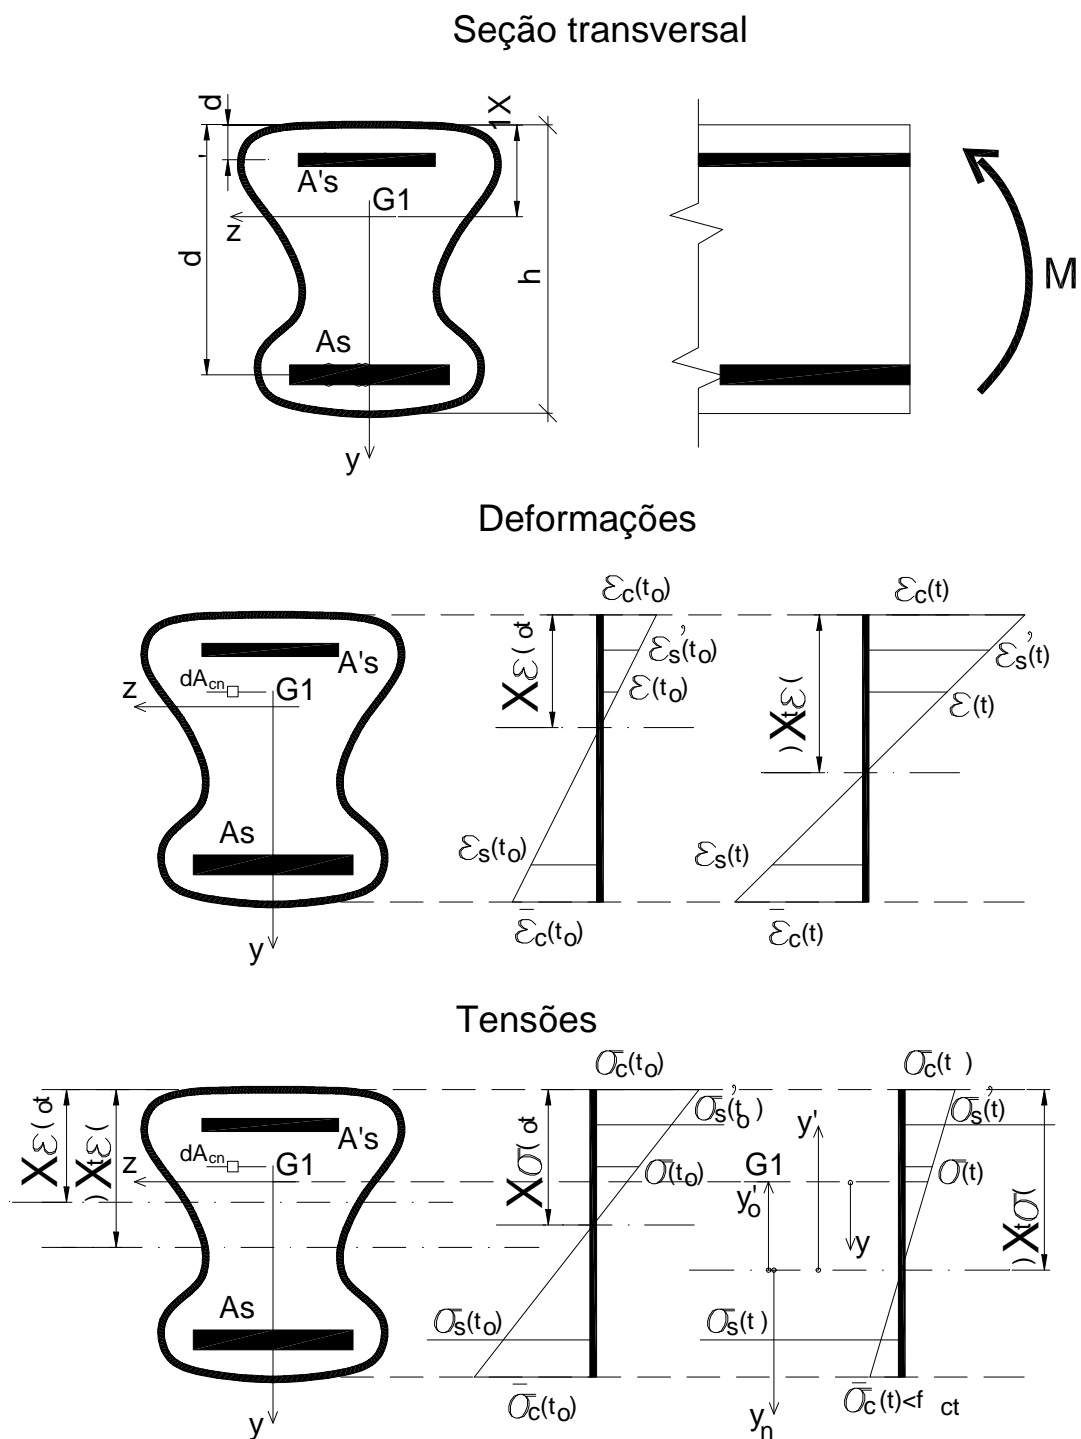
Tensões e deformações nos tempos “ t_0 ” e “ t ” para uma seção não-fissurada de concreto armado.
